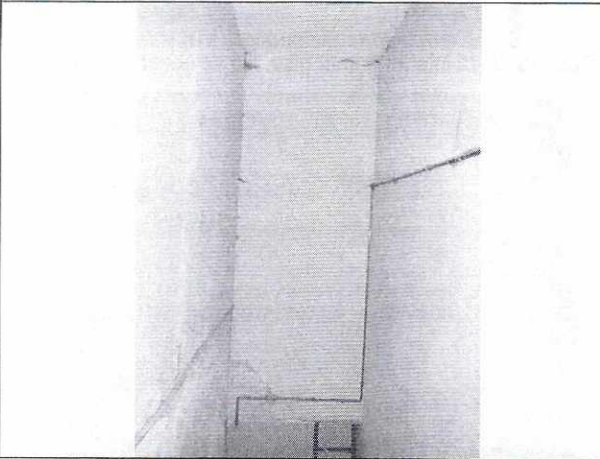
Vista interior hall acceso vivienda, tercer piso. No se observa daños
